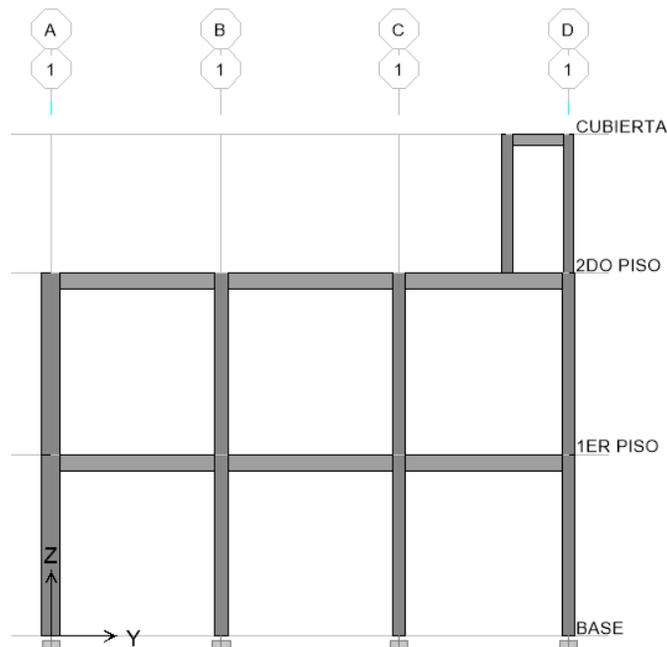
; Pórtico Eje 1. Del diseño estructural de hormigón armado
